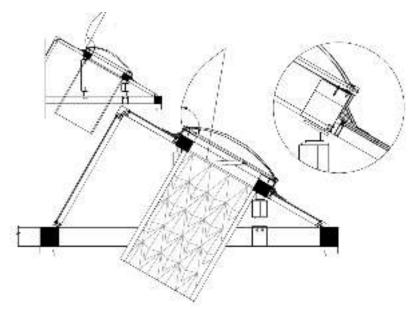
Поперечный разрез конструкции светового фонаря
